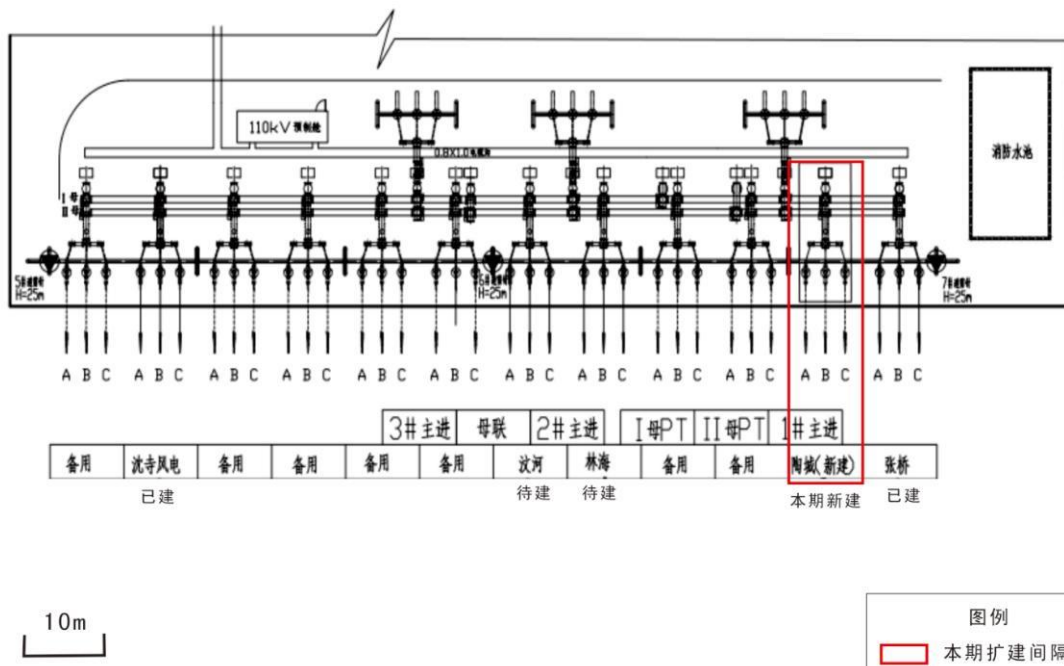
树海 220kV 变电站本期扩建间隔平面布置示意图
